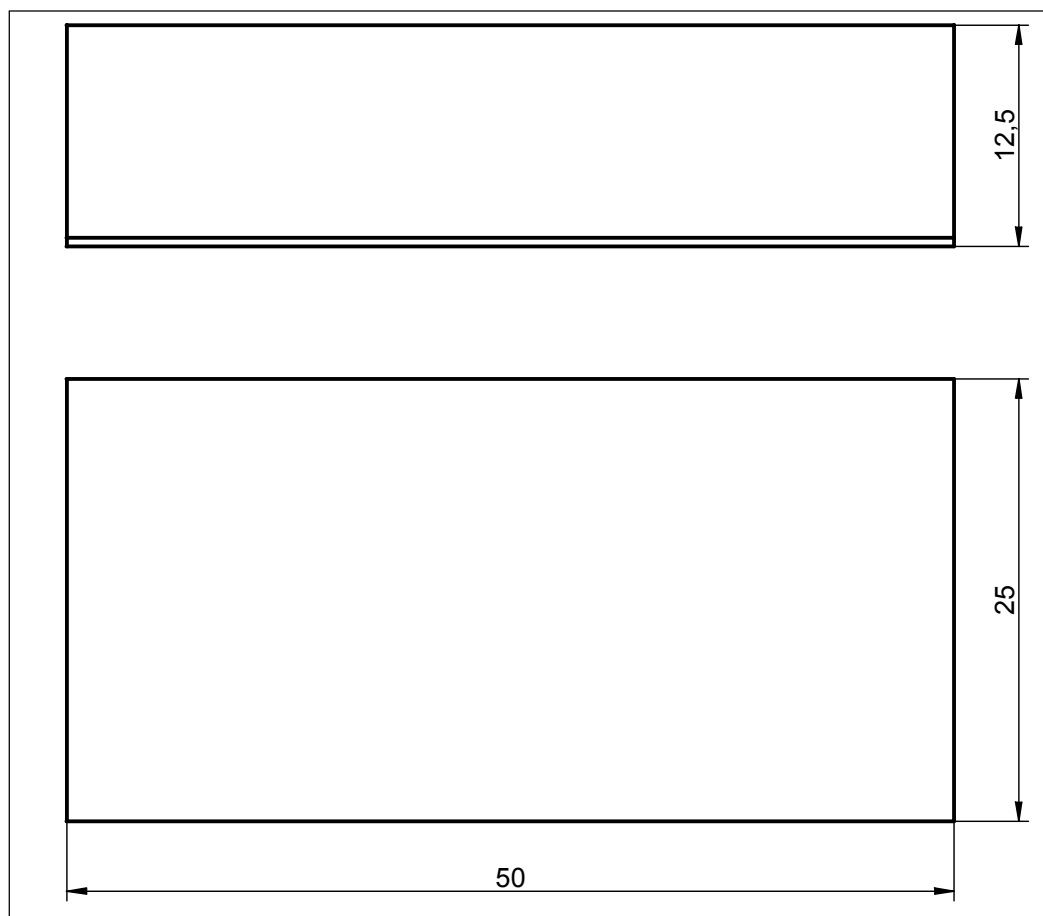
Vistas de alzado y planta del edificio (dimensiones en metros)
